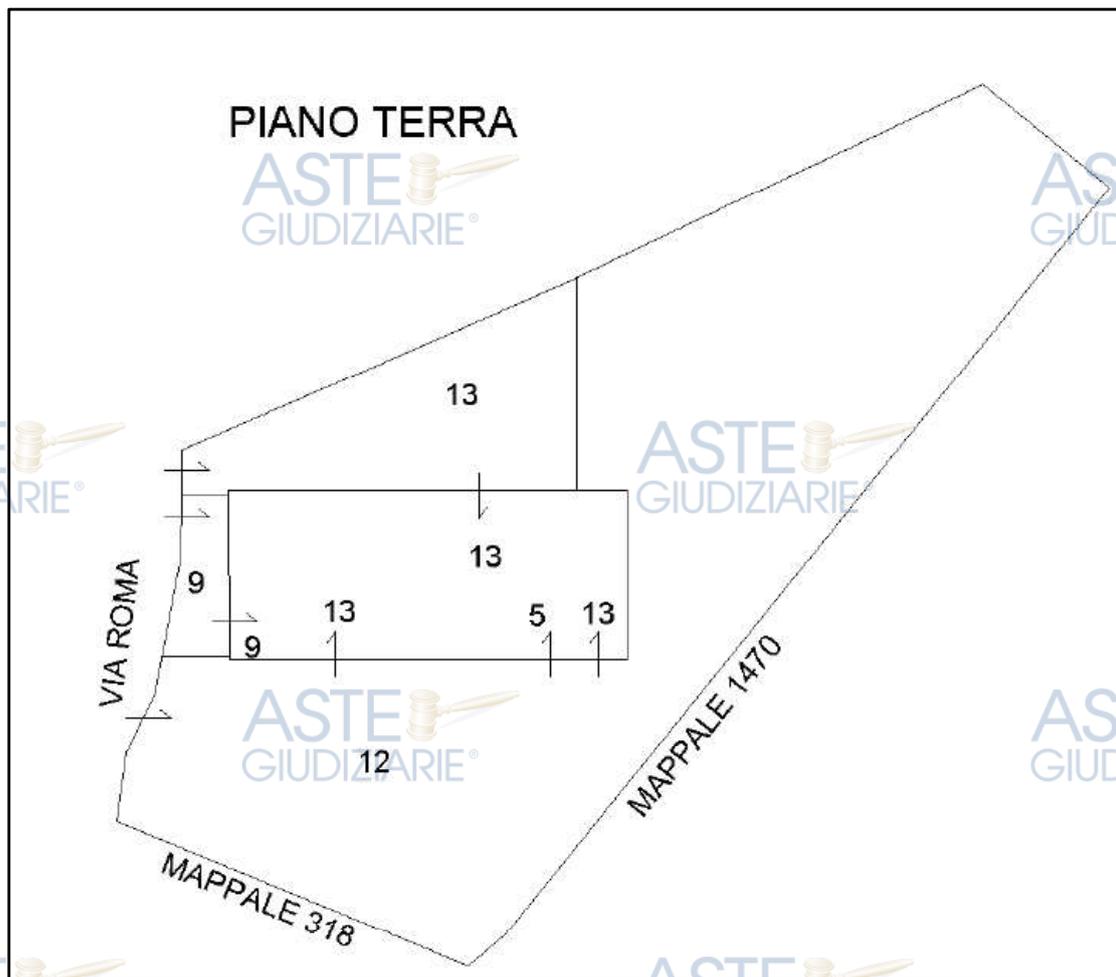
Estratto dell'elaborato planimetrico attuale (dimostrazione grafica subalterni)
